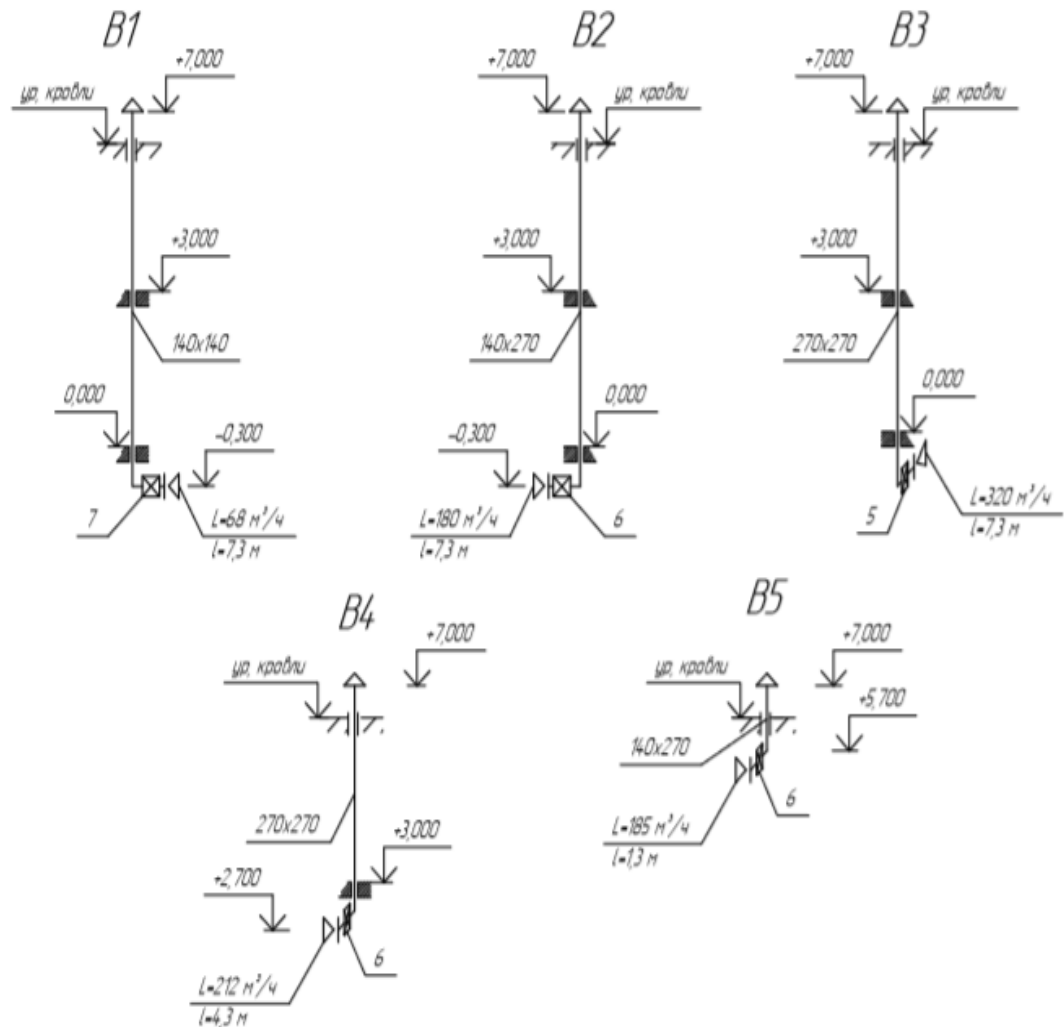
Расчетные схемы механических системы вытяжной вентиляции дома
